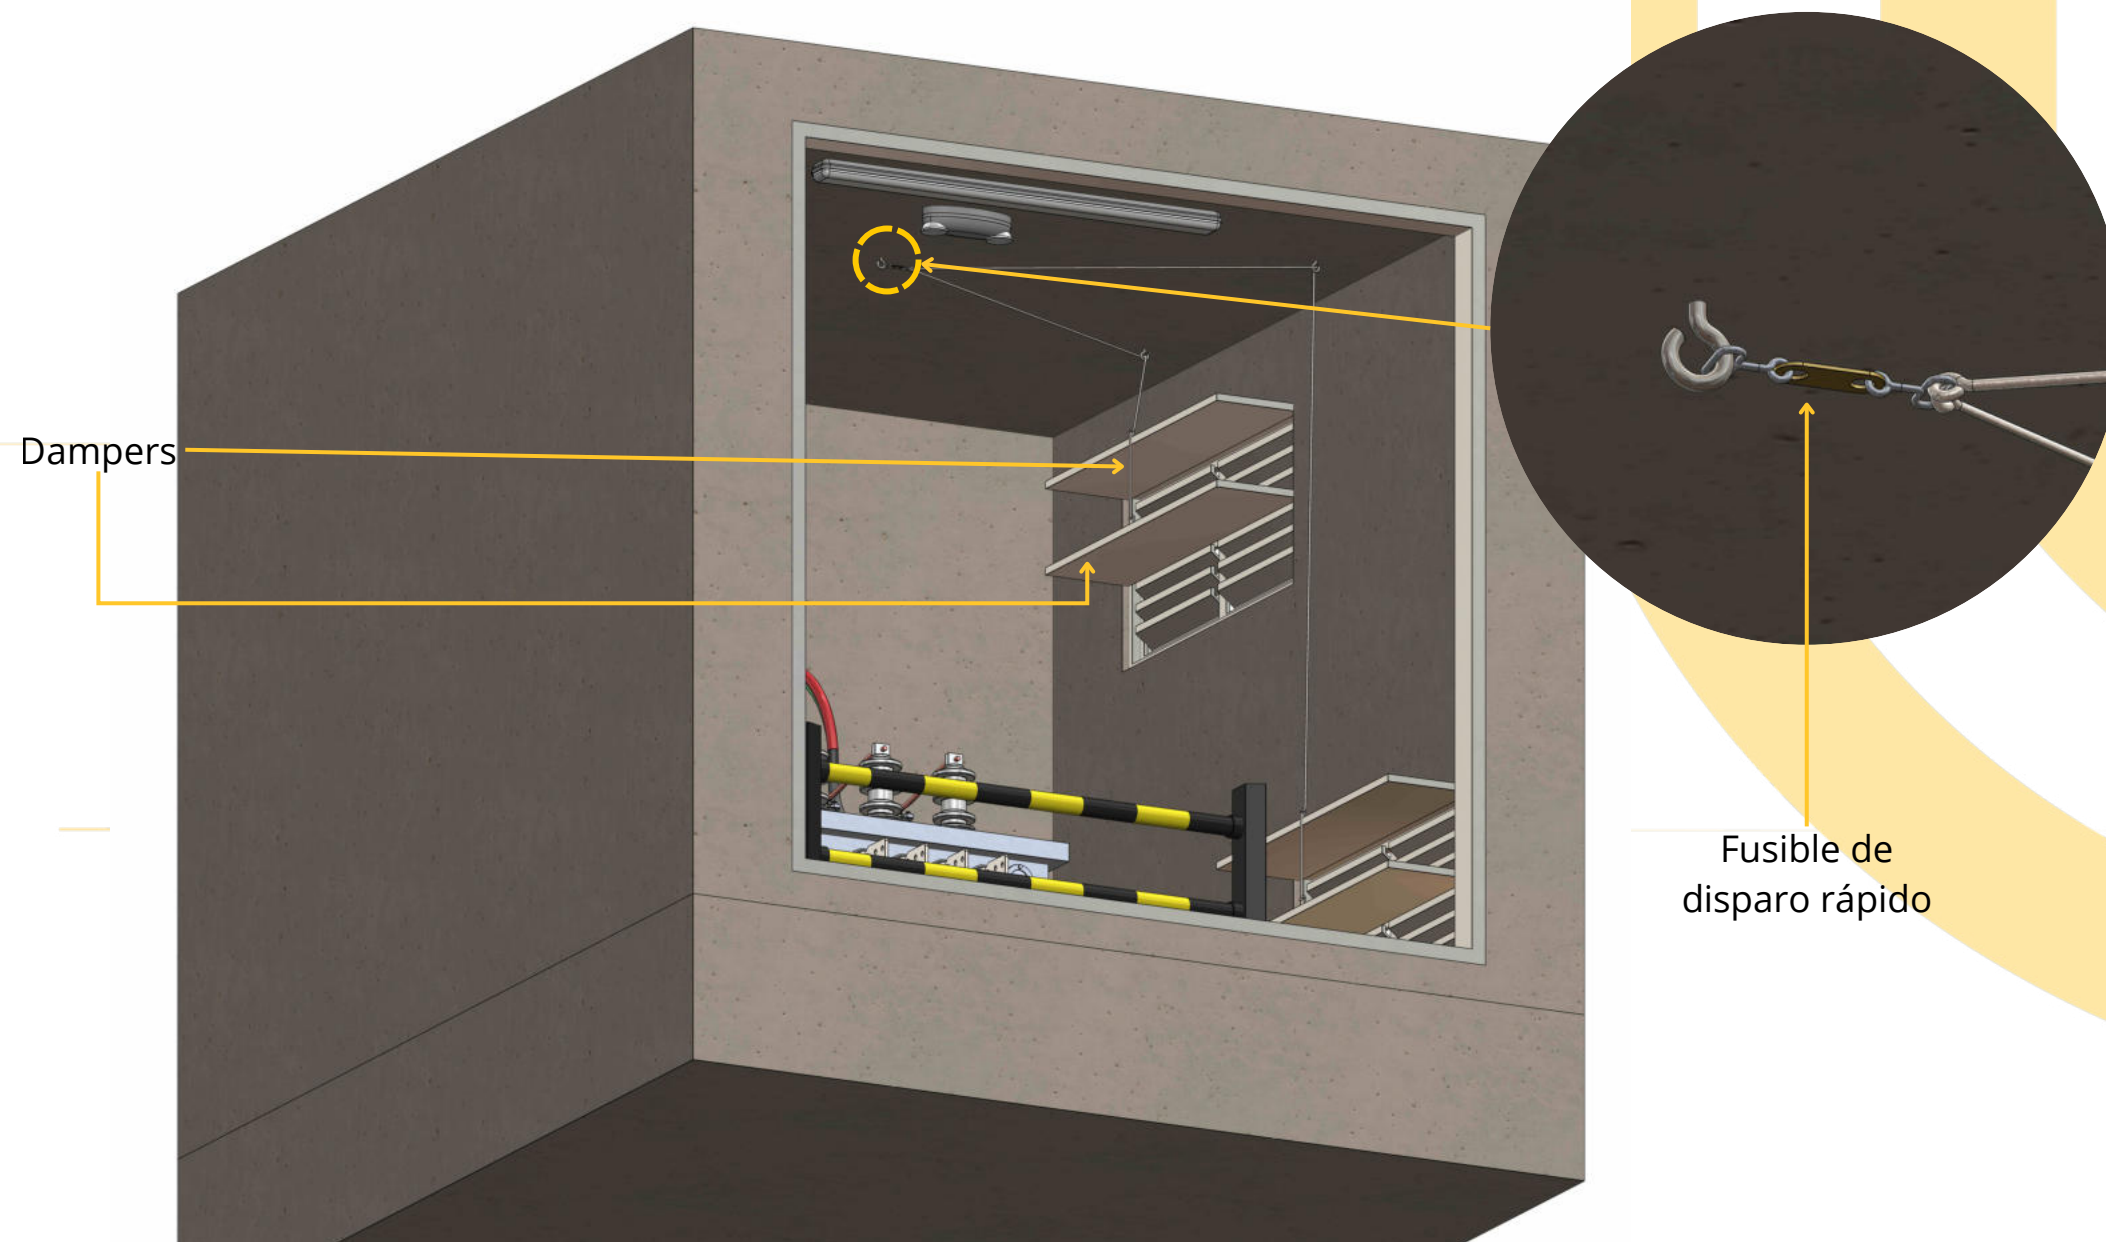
Detalles de Dampers y ventilación de cerramiento: centro de transformación tipo interior en aceite
